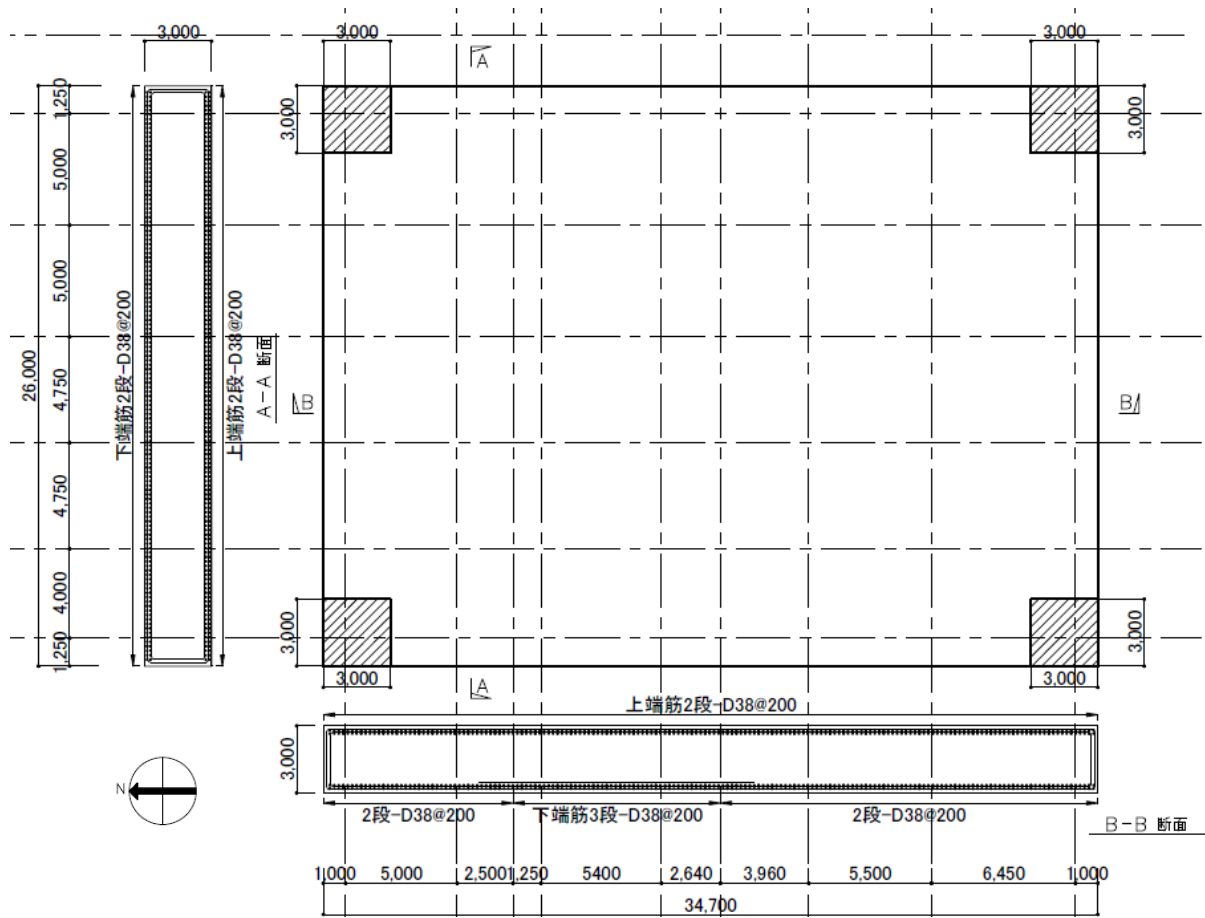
2. 4-3 基礎の配筋図 (単位 : mm)
